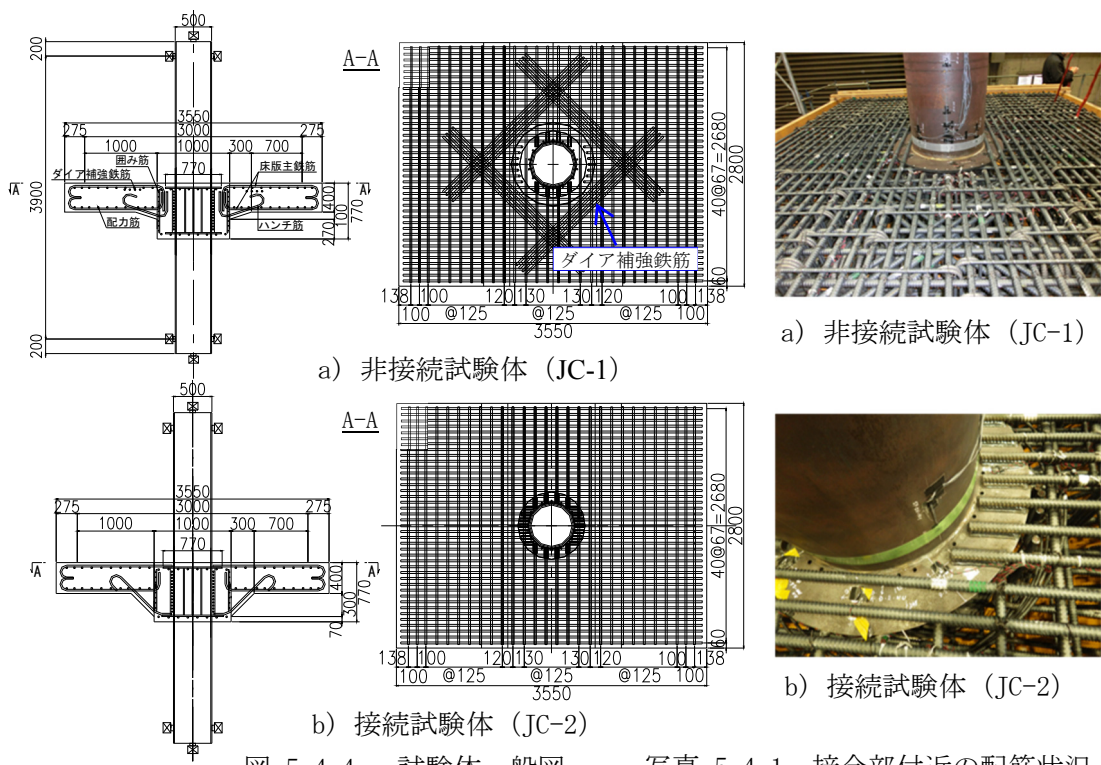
試験体一般図 写真-5.4.1 接合部付近の配筋状況
